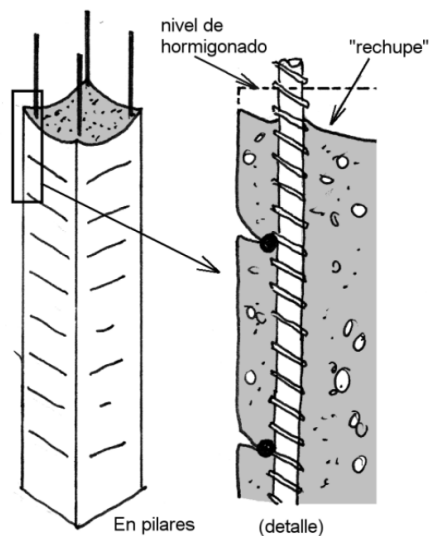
Fisura transversal en columnas (Fuente, MPE)
